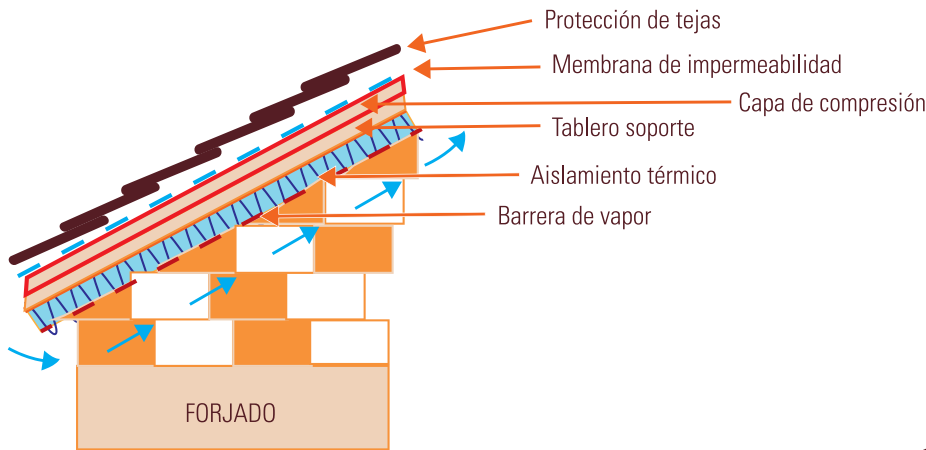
Cubierta fría con aislamiento en cara inferior de faldón
